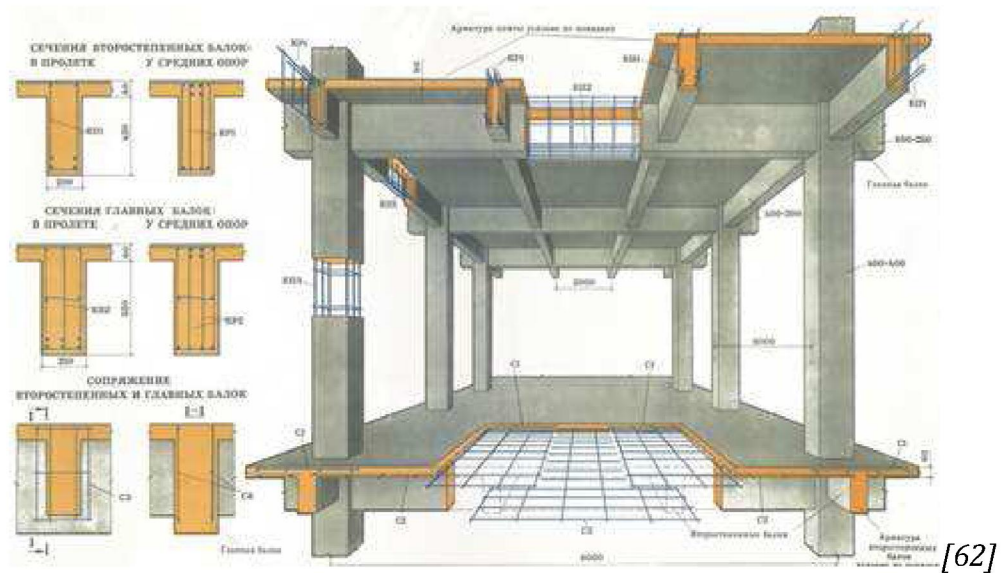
монолитное ребристое перекрытия с балочными плитами
